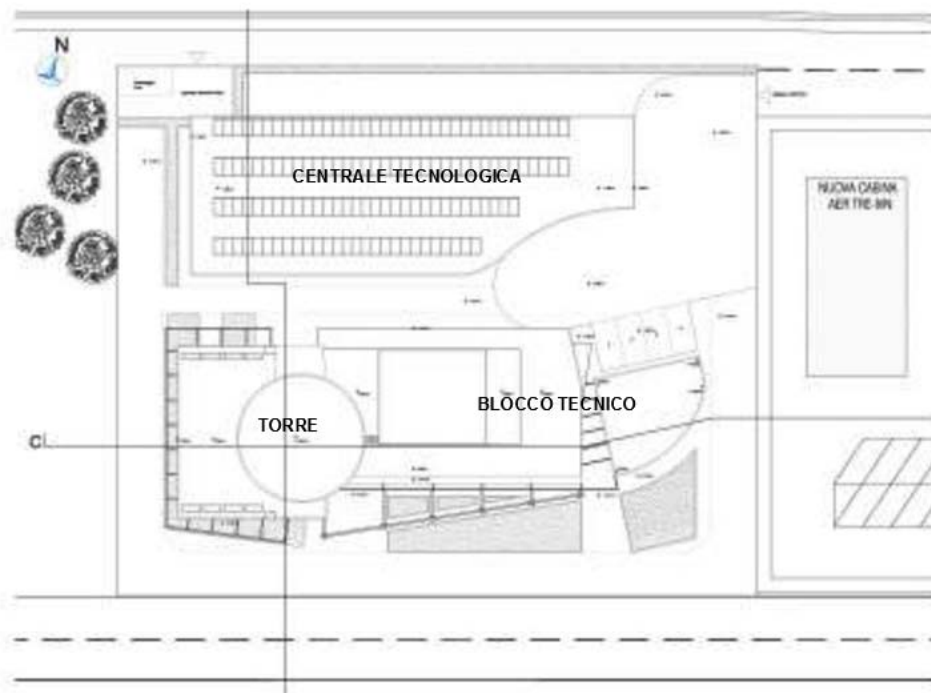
Schema planimetrico. Fonte: Ente Gestore
